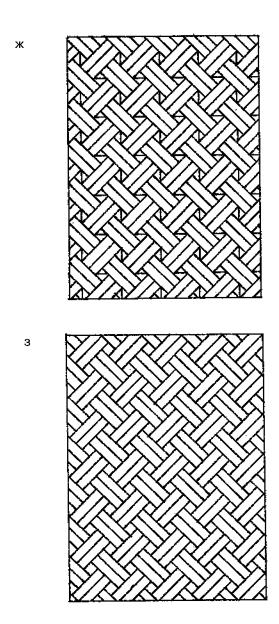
(продолжение)*. Варианты укладки планок паркета: ж — плетенка в две планки; з — усложненная плетенка в две планки
